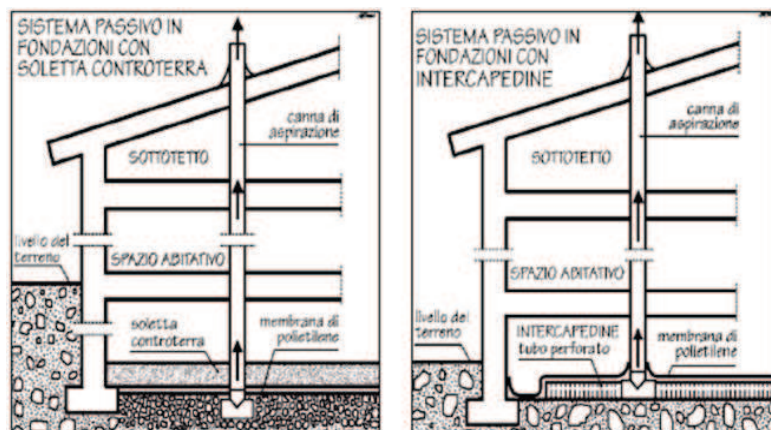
Sistema passivo in fondazioni con soletta controterra; Fig. 2 – Sistema passivo in fondazione con intercapedine.
